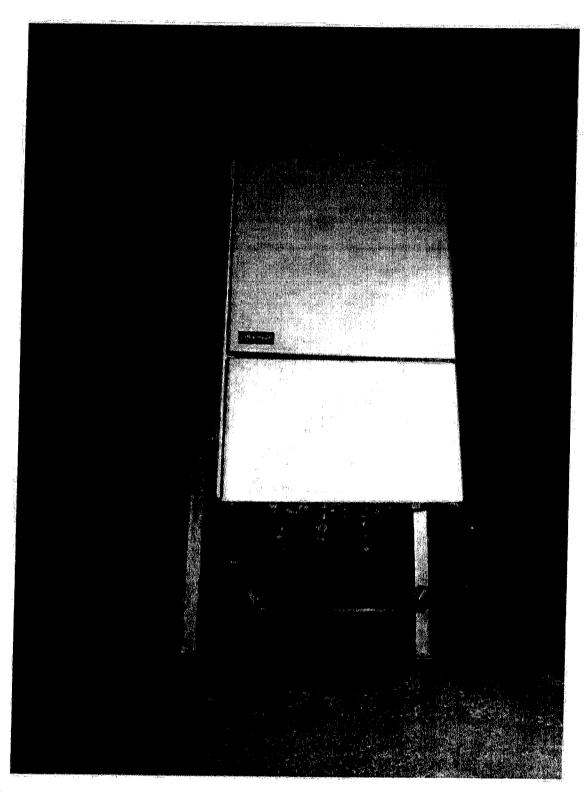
Rilievo interno – La caldaia a gas Metano a servizio dell'alloggio del secondo piano posizionata al piano sottotetto (pertinenza Sub. 3).
